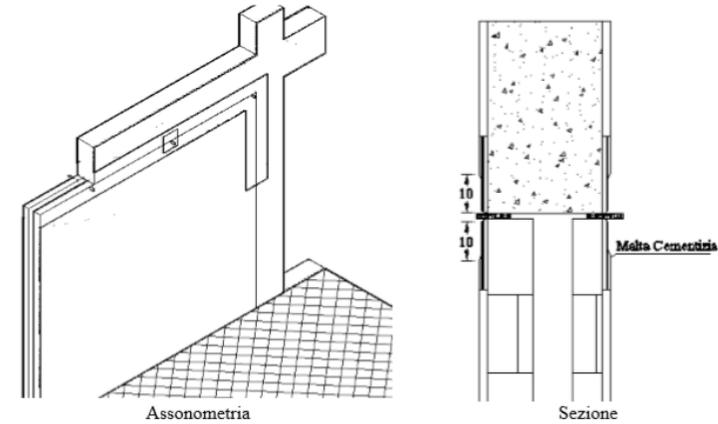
Applicazione di un secondo strato di malta cementizia bicomponente ad elevata duttilità
